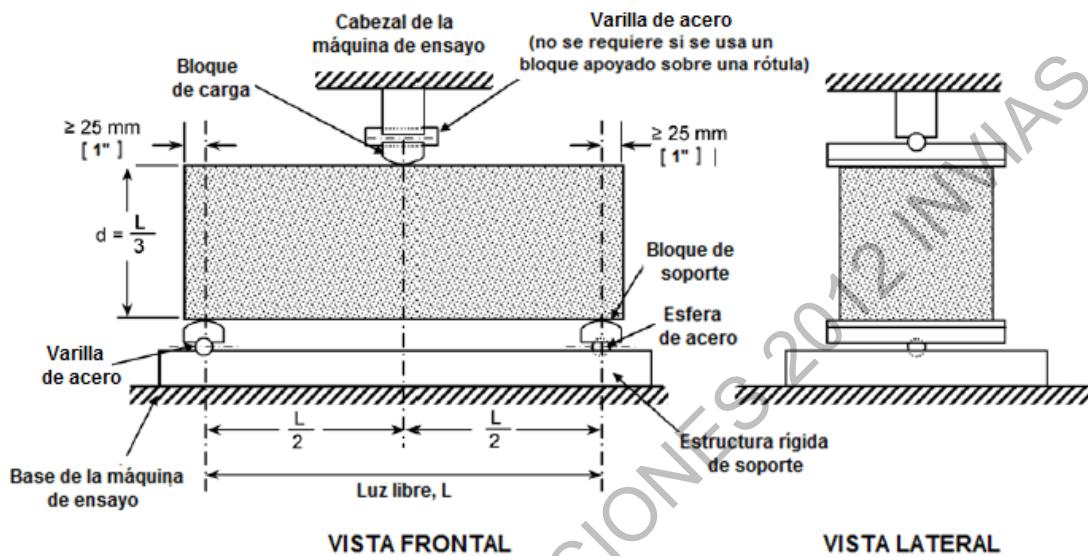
1. Diagrama de un equipo adecuado para el ensayo de flexión del concreto usando una viga cargada en el centro de la luz
